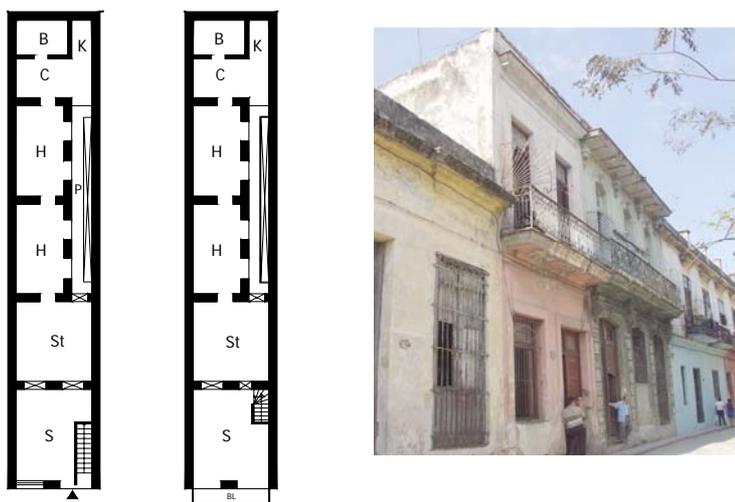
Damas 860, primera mitad del siglo XX, plantas y fachada
